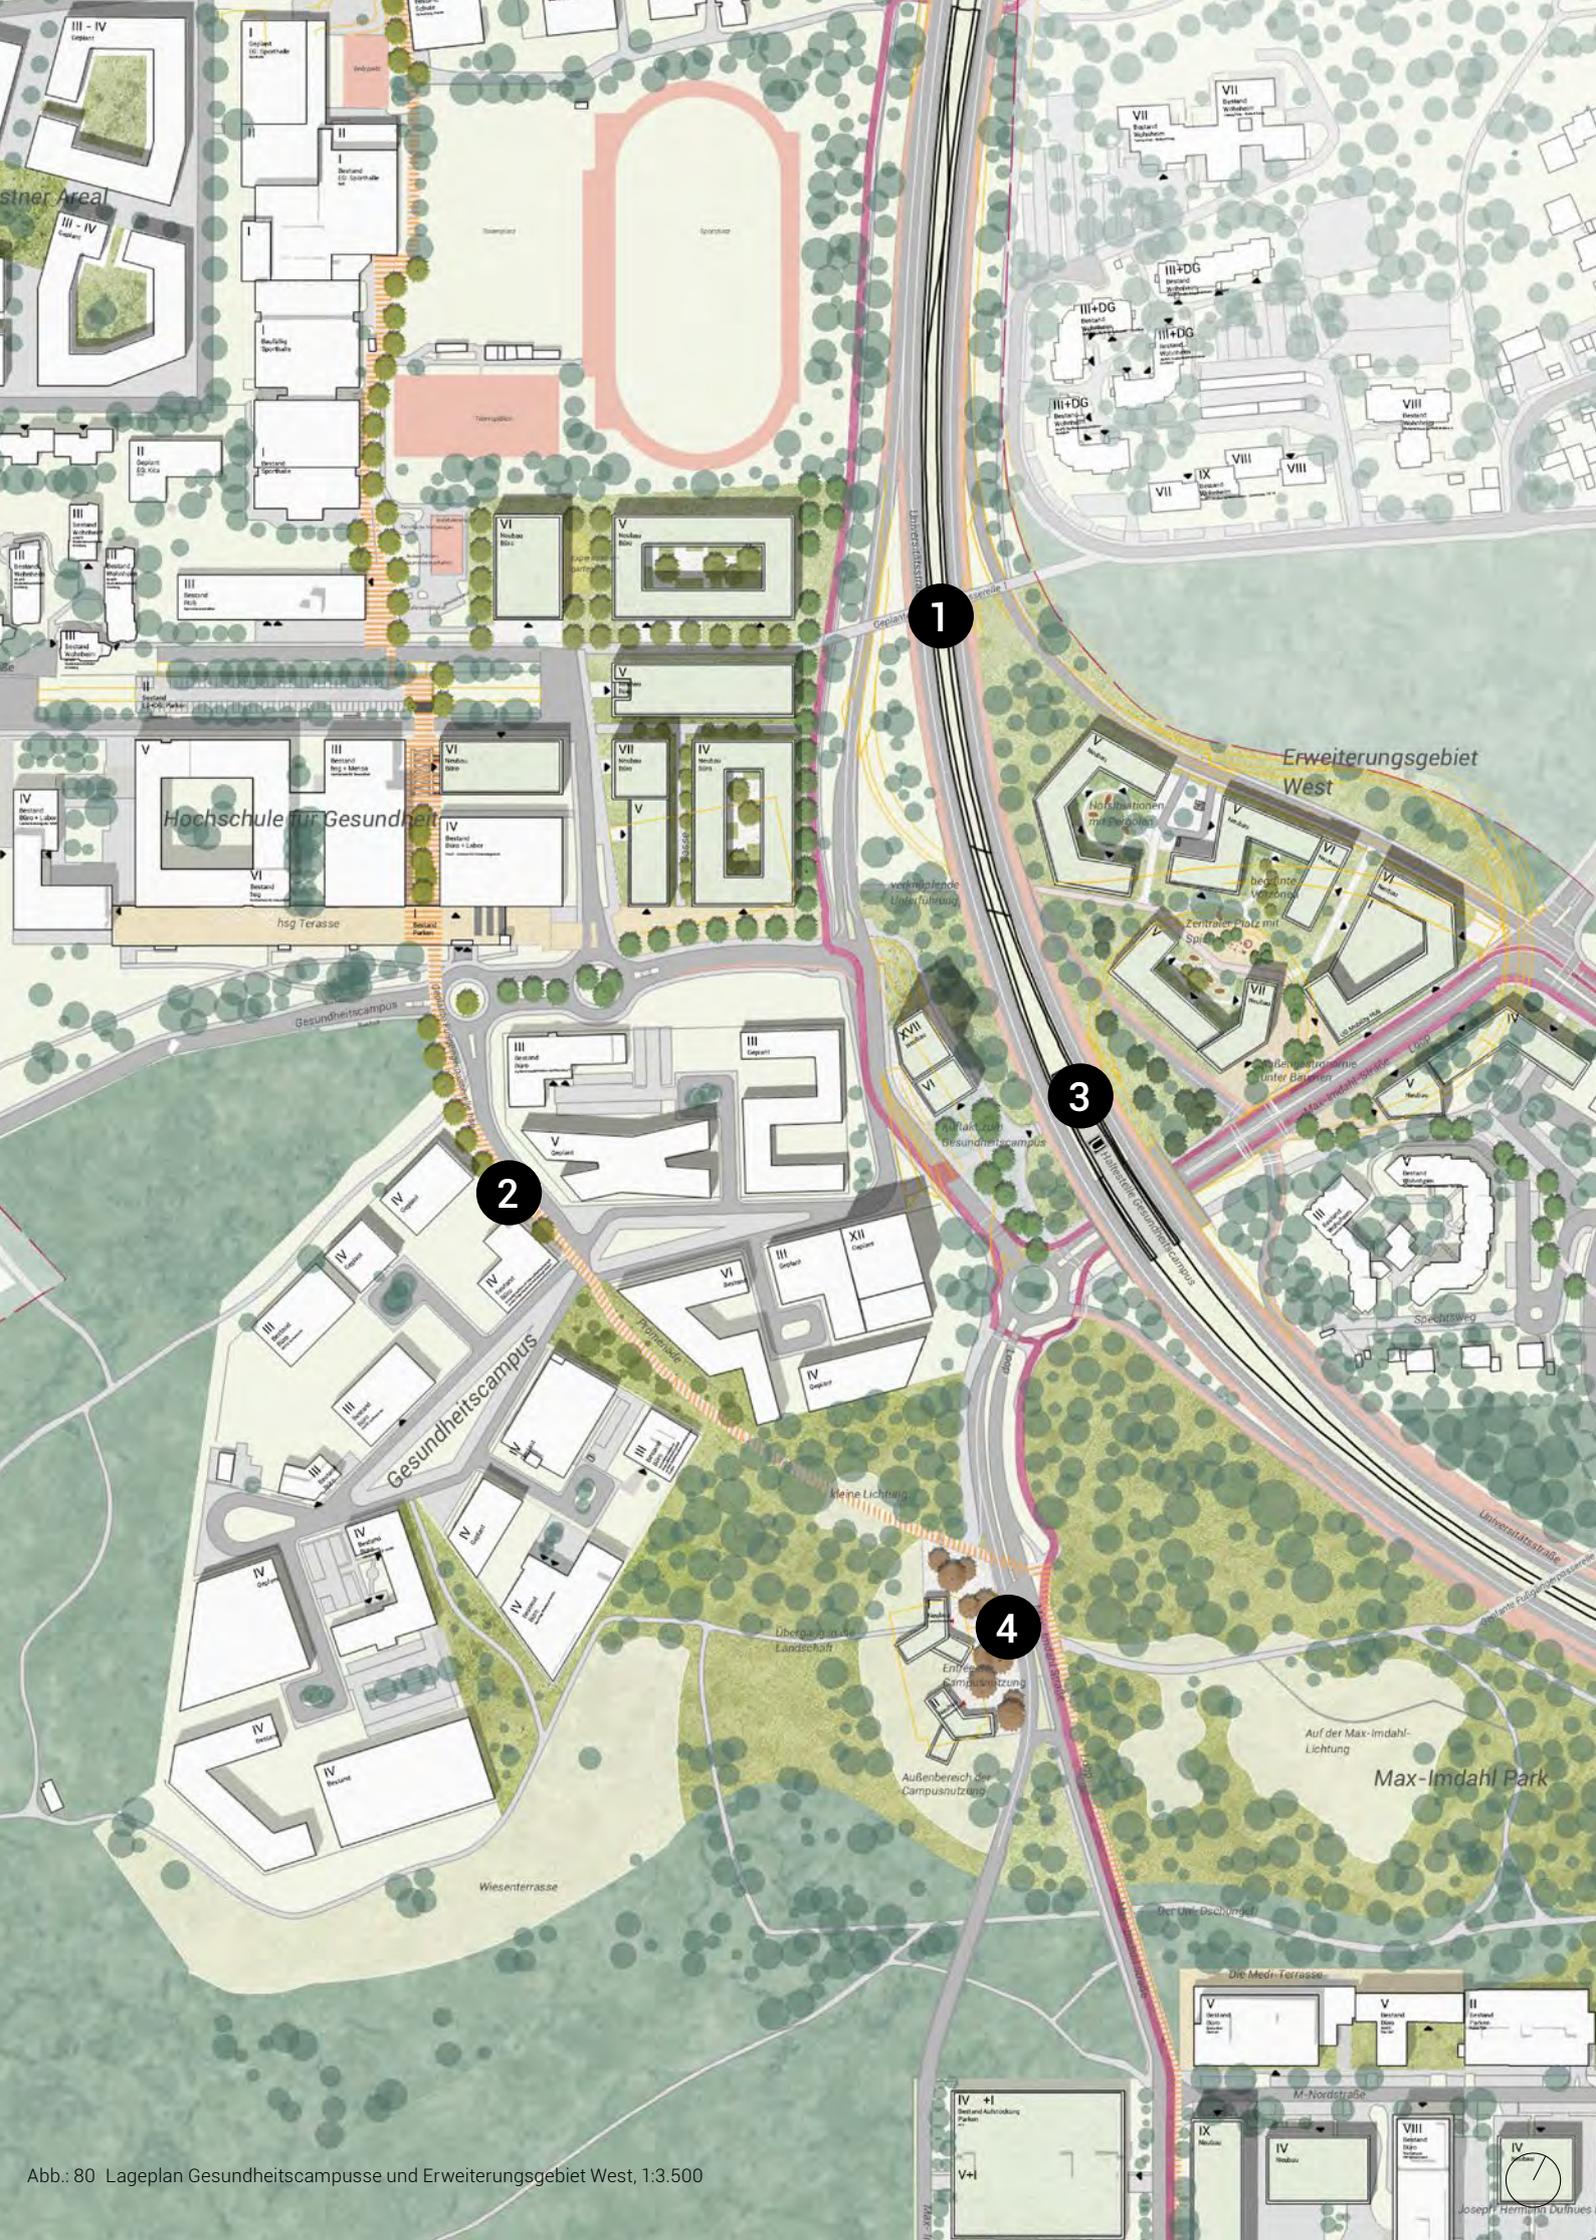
Lageplan Gesundheitscampus und Erweiterungsbau West, 1:3.500
